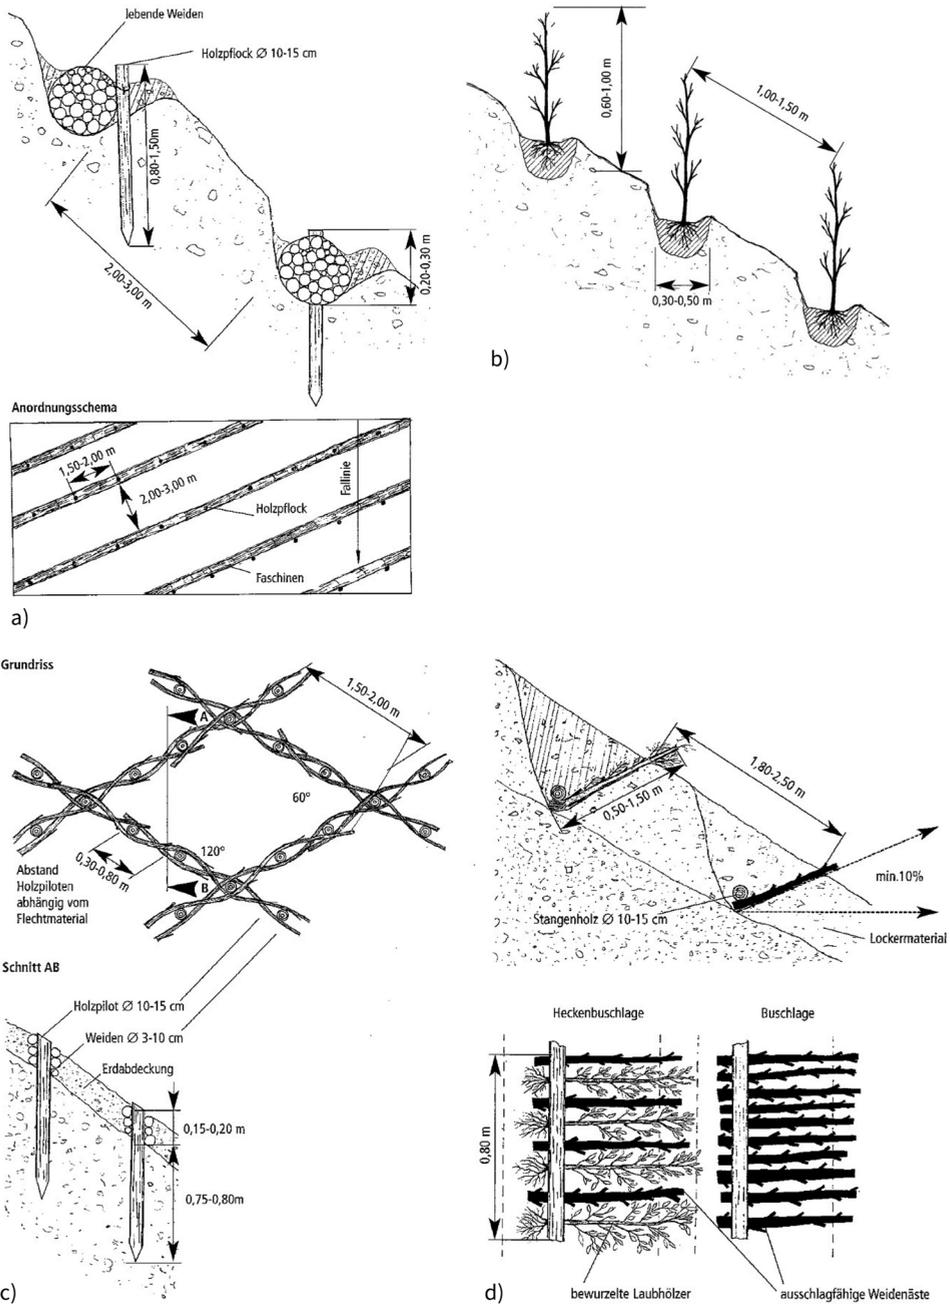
Beispiele ingenieurbioologischer Sicherungsmaßnahmen: Hangfaschinen, Hangbepflanzung, Rautengeflecht und Lagenbau (nach [21]); a) Hangfaschinen, b) Hangbepflanzung, c) Rautengeflecht mit Weidenflechtzaun, d) Lagenbau (lebend bewehrte Erde)
